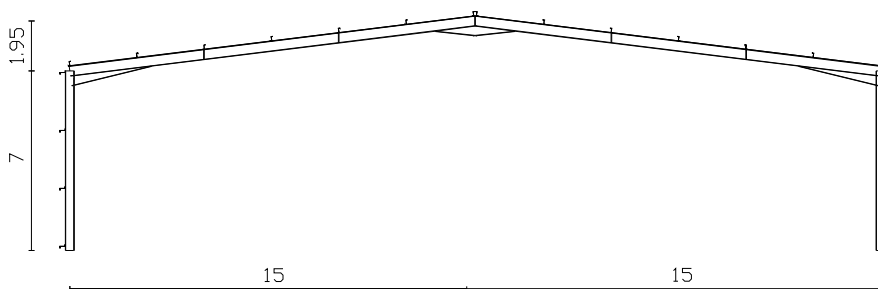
Pórtico rígido viga e pilar de alma cheia, vão de 30.00m com esquadros ligação pilar/viga, viga/viga
